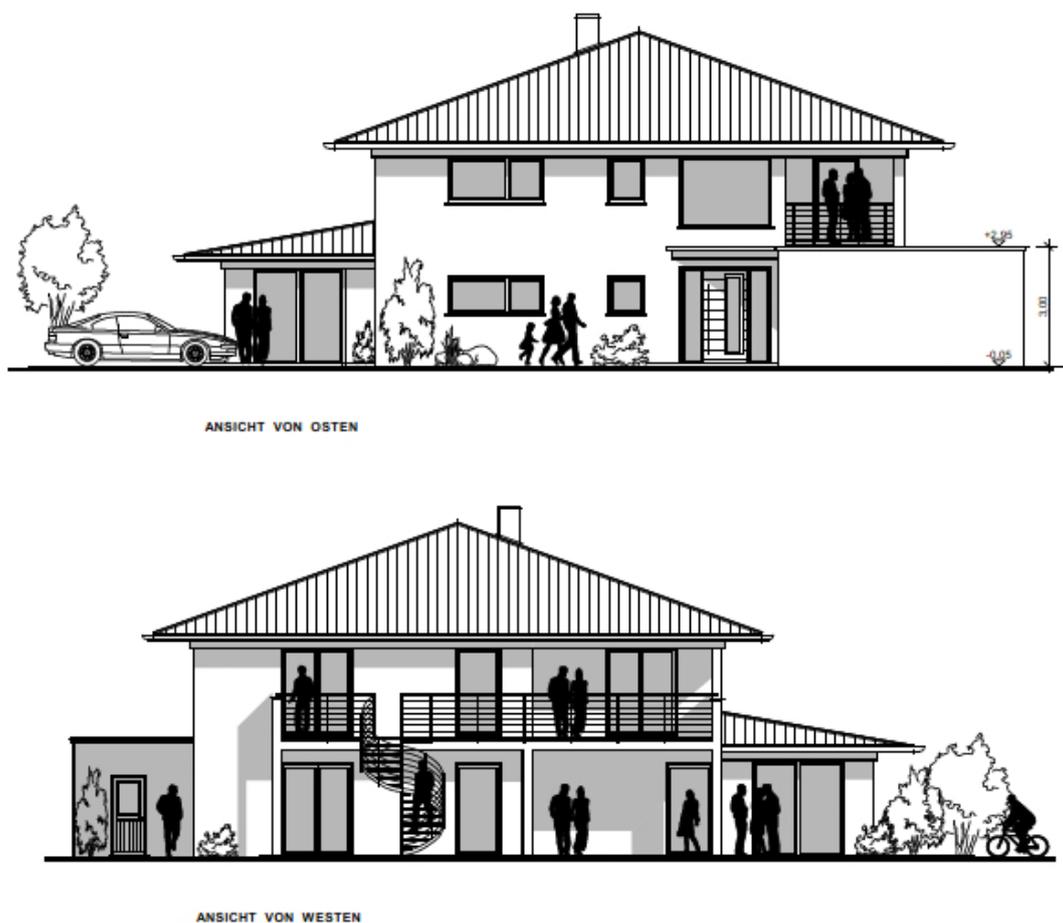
Geplante Bebauung auf Fl.-Nr. 17, unmaßstäblich
